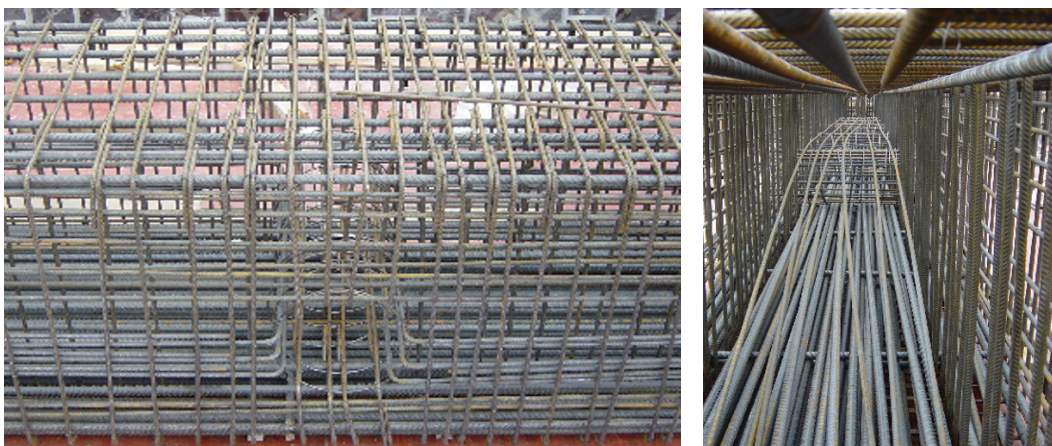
Bewehrungsgeflecht eines Unterzugs in zwei Ansichten an der Bauhausuniversität Weimar
